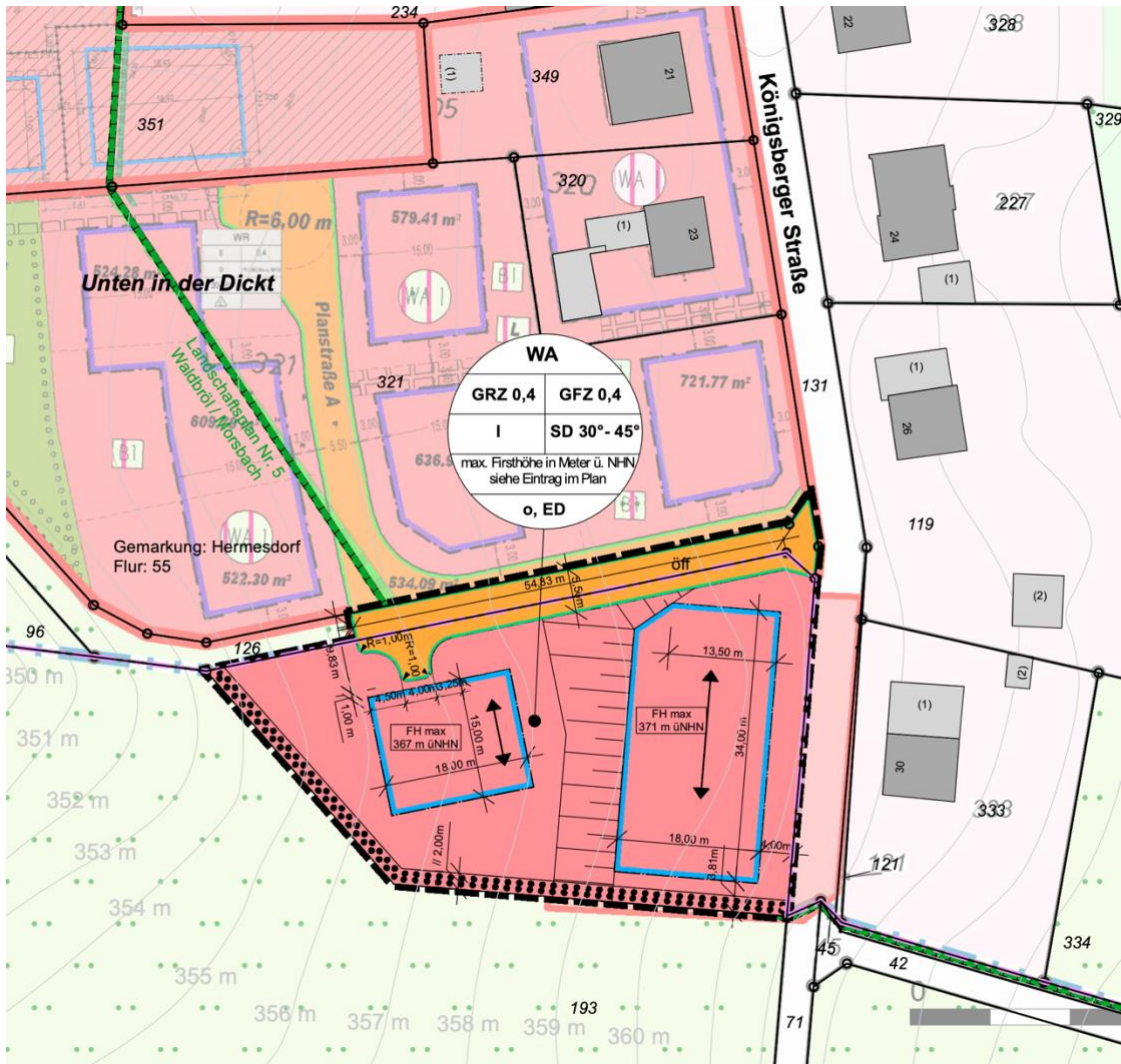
Bebauungsplan (Ausschnitt) im Entwurf (Stand 05.10.2023)
